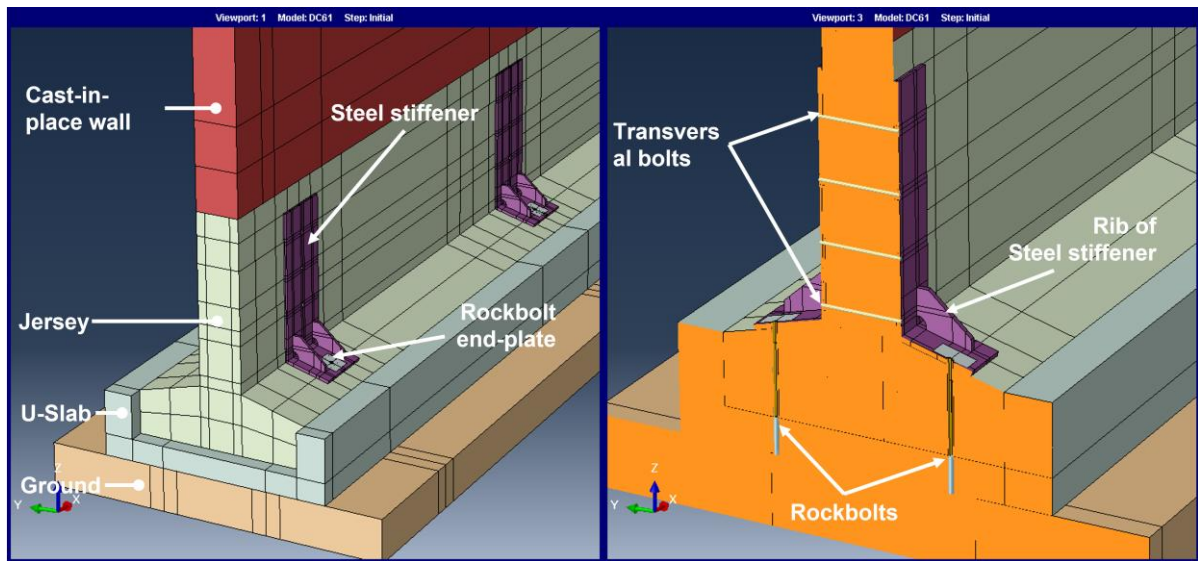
Geometría del muro prefabricado ("Jersey") junto con el resto de los elementos y el refuerzo considerado.
